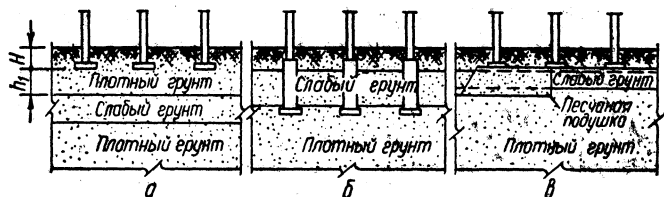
Типы фундаментов зданий с массивными стенами при слабом подстилающем слое грунта:
